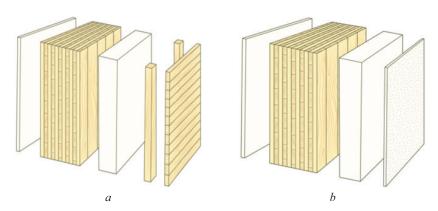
Примеры отделки наружных панелей: *а* — вентилируемый фасад; *b* — штукатурный фасад
